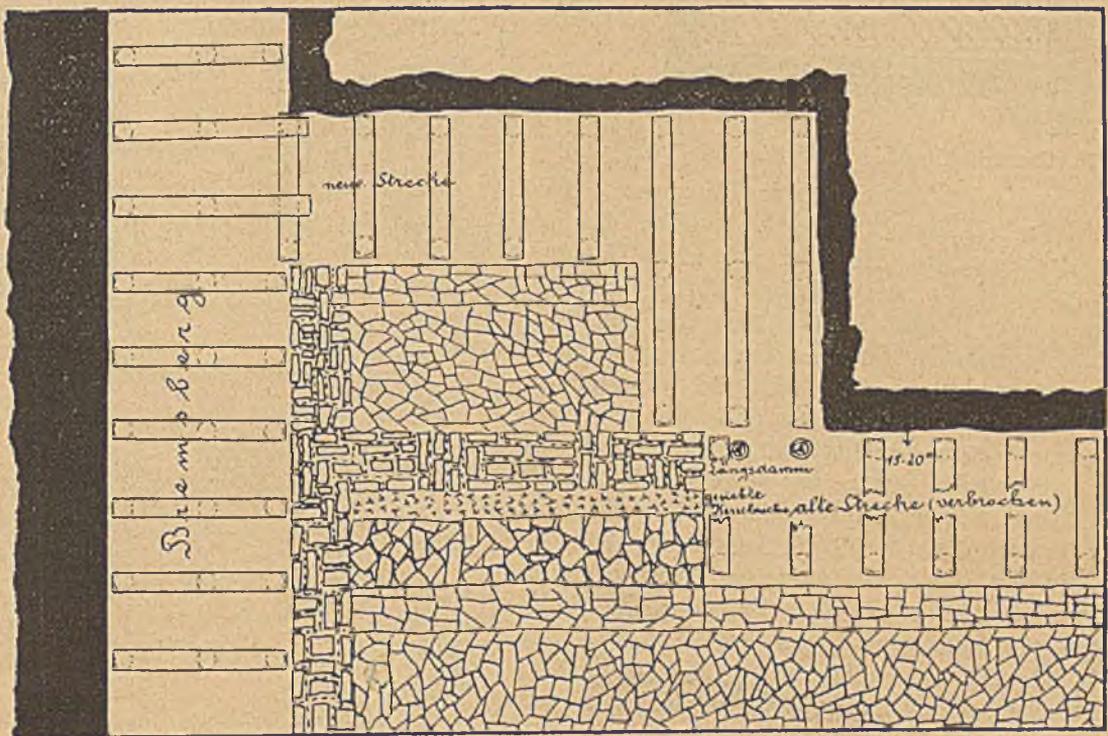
Steichender Stoßbau mit Flugaschen-Dämmen (Grundriß).
